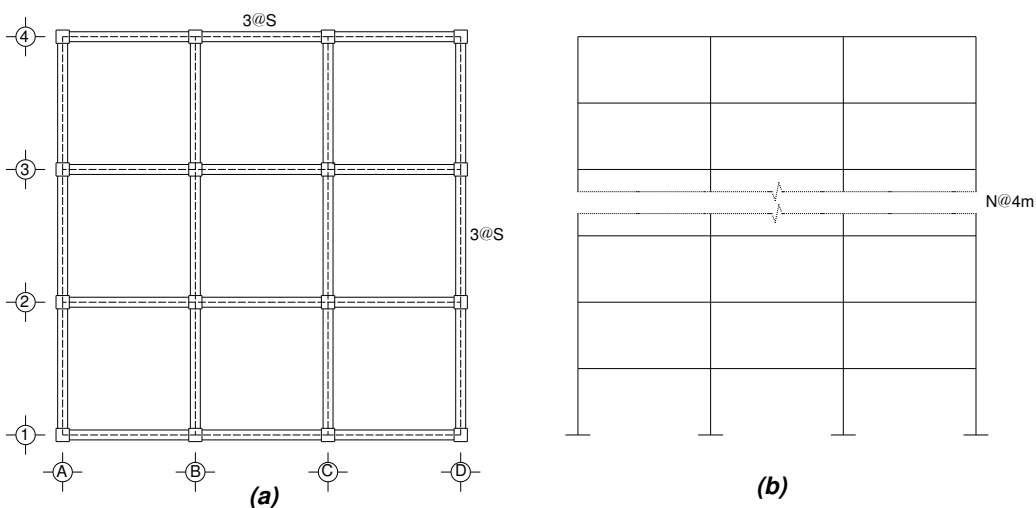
(a) Planta y (b) elevación de los edificios de C/R
